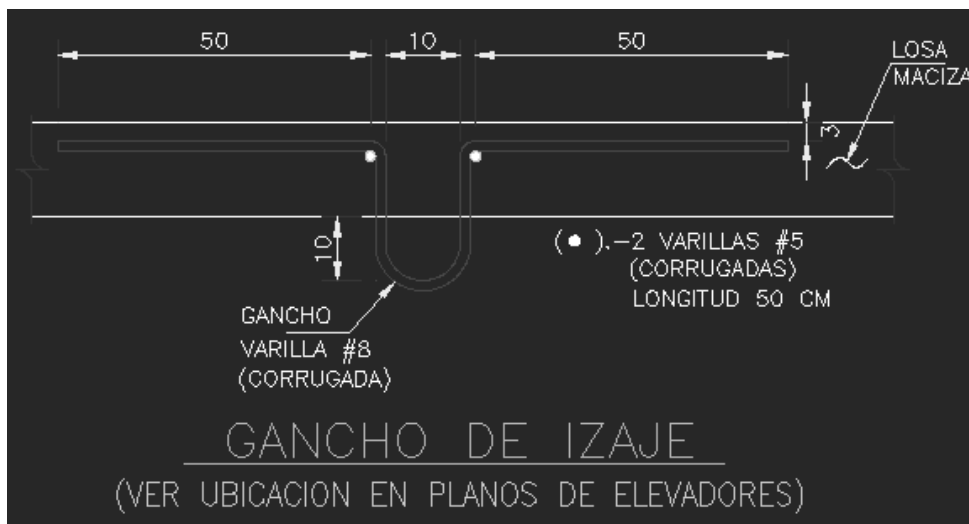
Detalle del anclaje para el izaje de elevador y montacargas.
